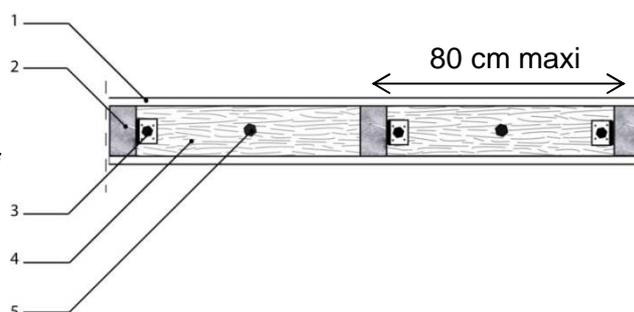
Schémas de principe d'un panneau courant de refend (coupe horizontale)
